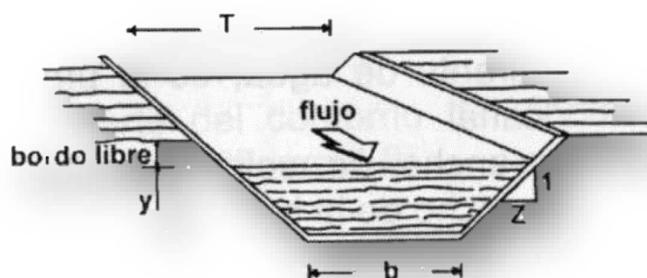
Sección Transversal. (Fuente: Villon,(2007)).
